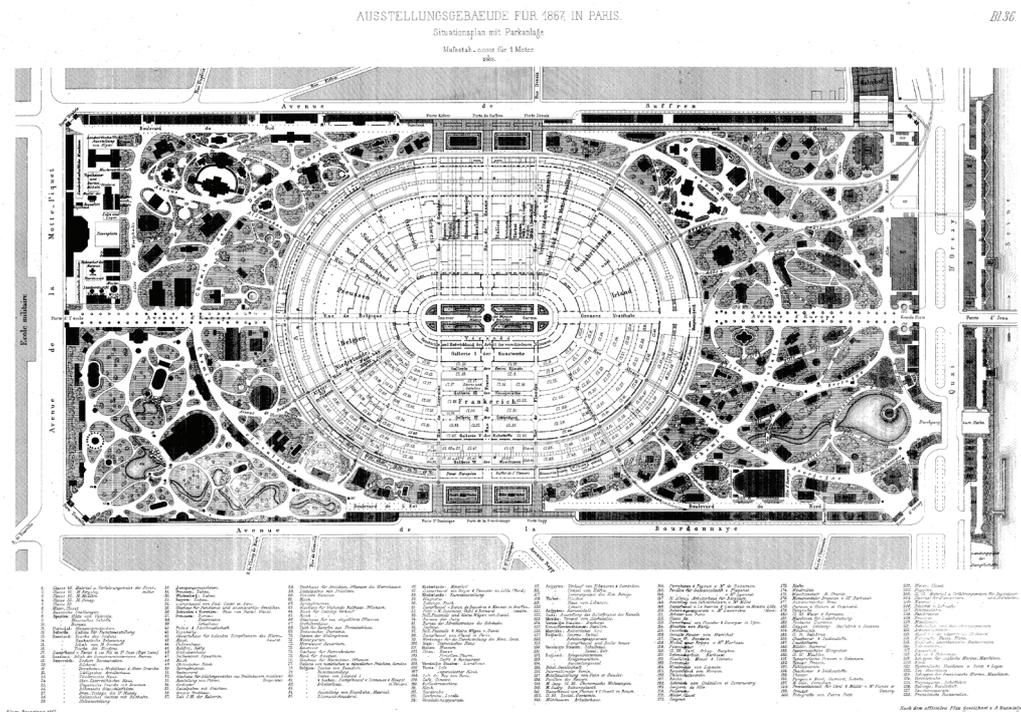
Lageplan der Pariser Weltausstellung 1867
